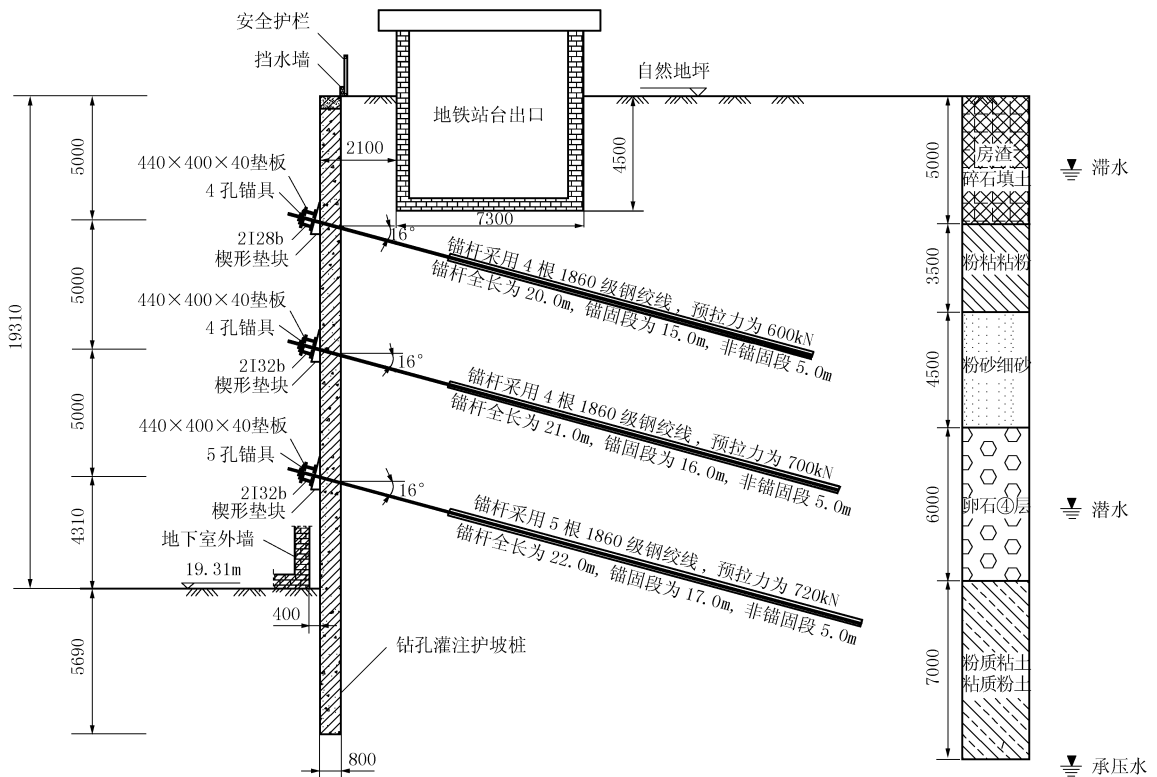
基坑深度 19.31 m 紧靠地铁站台处支护剖面图
